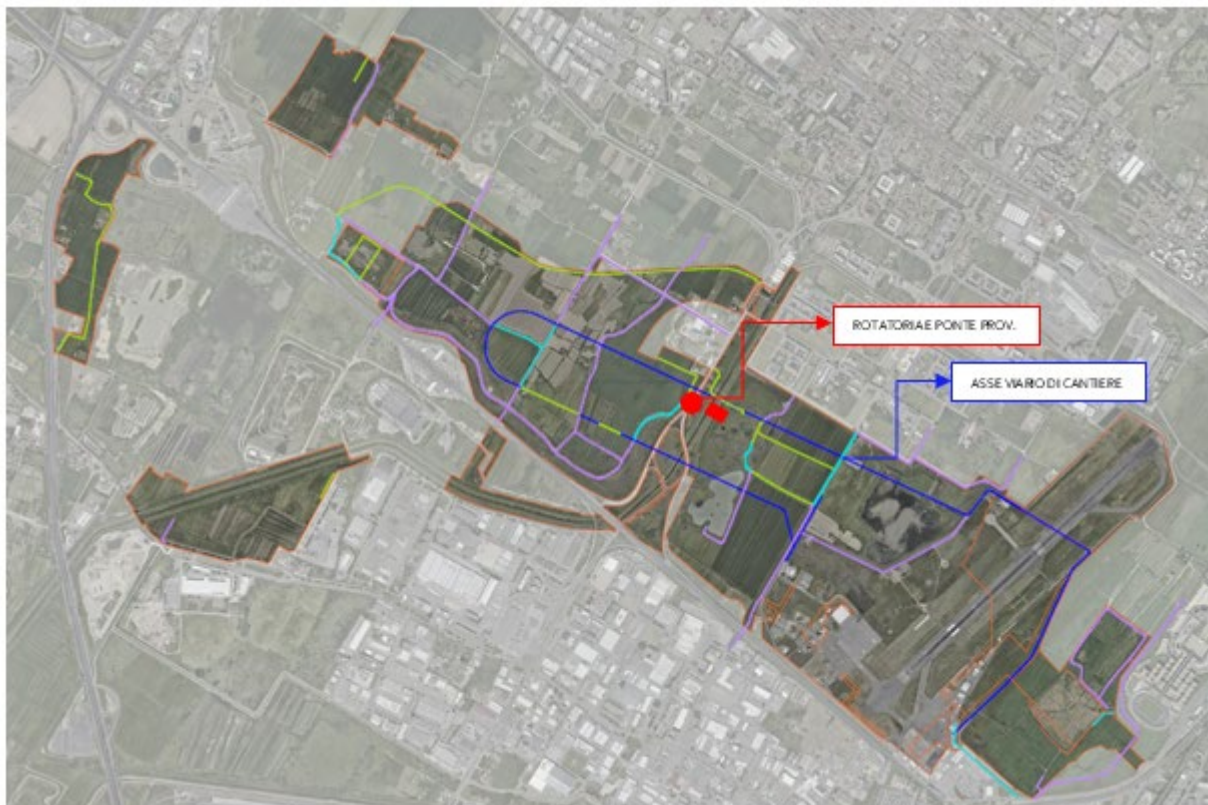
Planimetria di cantierizzazione: viabilità di cantiere
